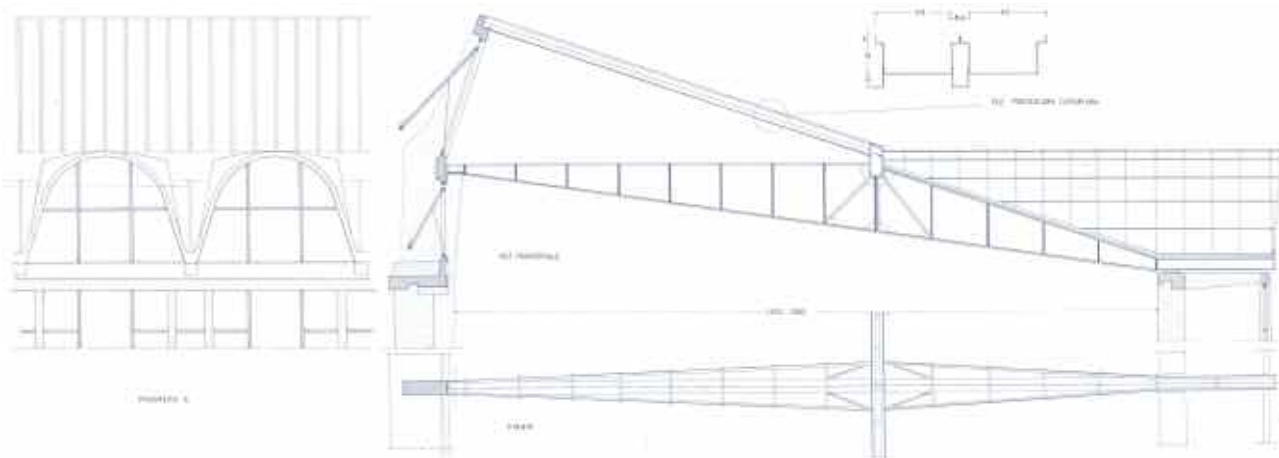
La struttura portante della copertura (Fondazione Michelucci, Firenze).
